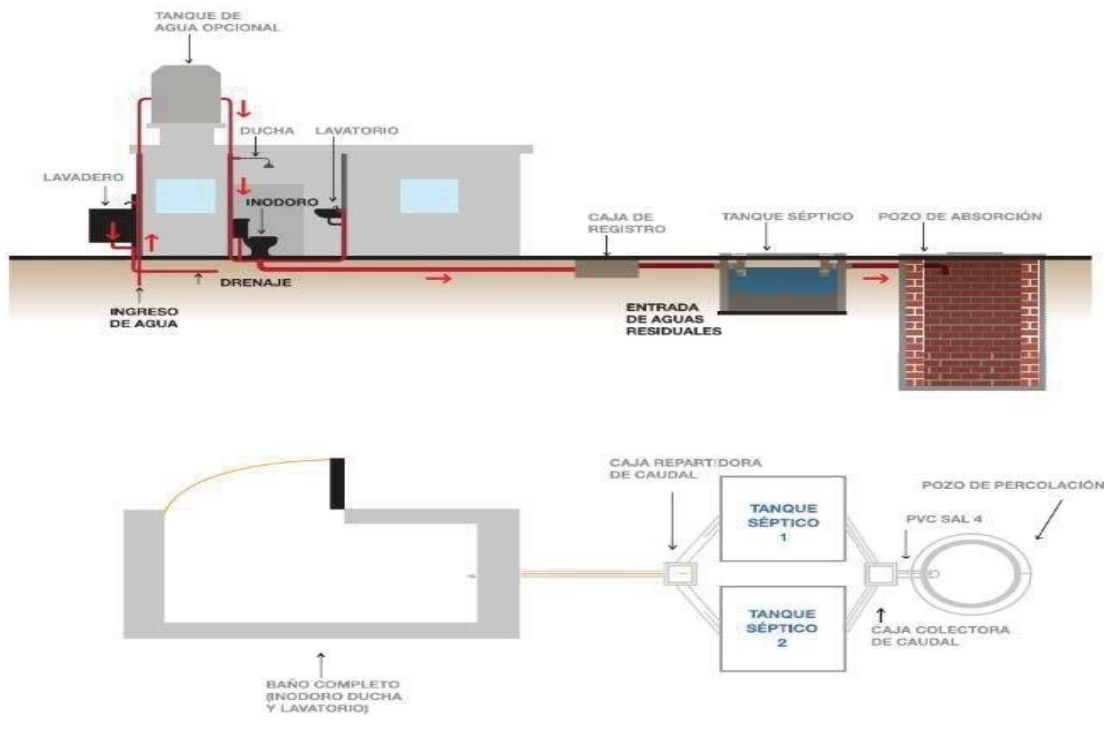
Vista en corte y planta de UBS de arrastre hidráulico con tanque séptico
